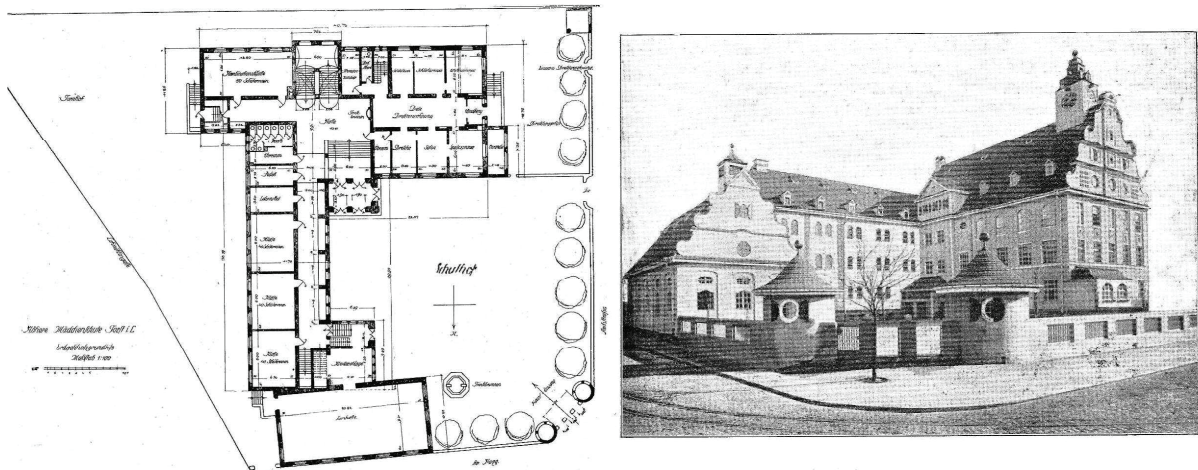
Höhere Mädchenschule (Luisenschule) in Forst i.L. (Lageplan mit Grundriss und Ansicht, Bj: 1908): Architekten: BECK & HORNBERGER in Dresden. Das Schulhaus soll durch das Zurücktreten der Gebäudemasse von der Straße „überschaubarer“ gestaltet wirken. Gebäude und Umwehung mit Baumreihe umschließen den vorgelagerten Schulhof. Eingang zum Schulgrundstück auf Eck mit Türmchen. Rückwärtig dem Gebäude: Schulgarten mit Gartenlaube für Außenunterricht. Innen: Eingangshalle verbindet den Hauptbau (mit rückwärtigen/ gartenseitigen Klassenzimmern) und Giebfügel (EG: Direktorwohnung. OG: Aula). UG: Schuldienervohnung, Dunkelkammer, Materialienraum, Gartengeräterraum und Heizungskeller. In: Das Schulhaus. 1912. 14. Jahrgang. S.16, 19.
